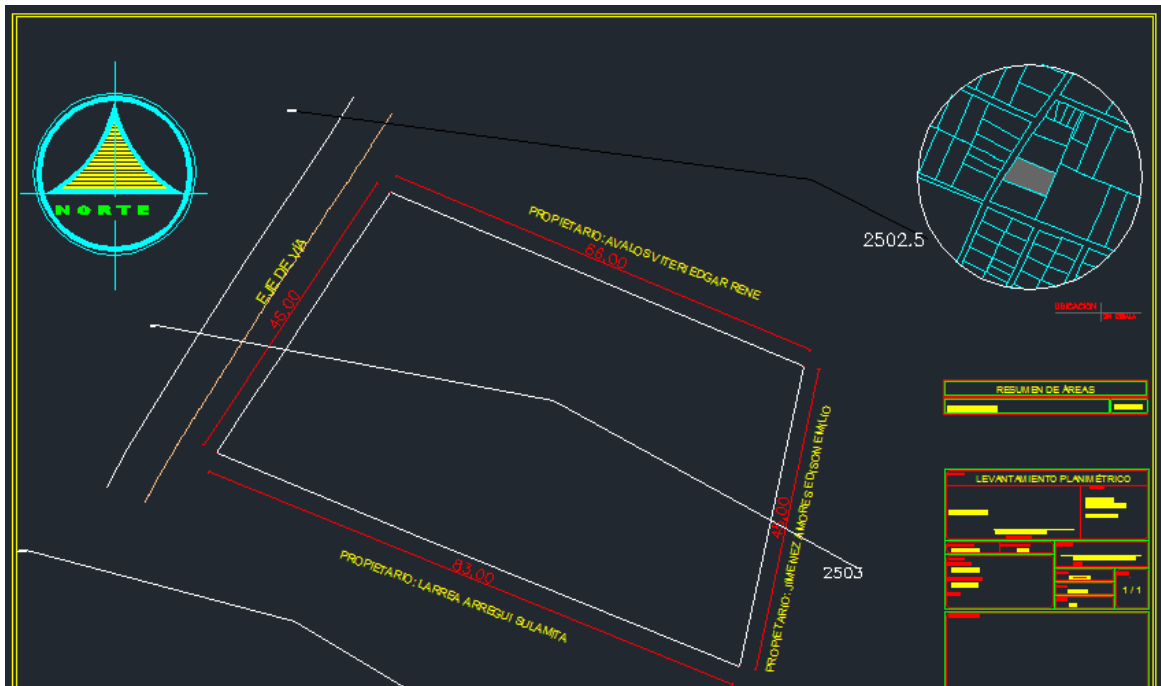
Planimetría del Terreno – Proyecto Vallevento
